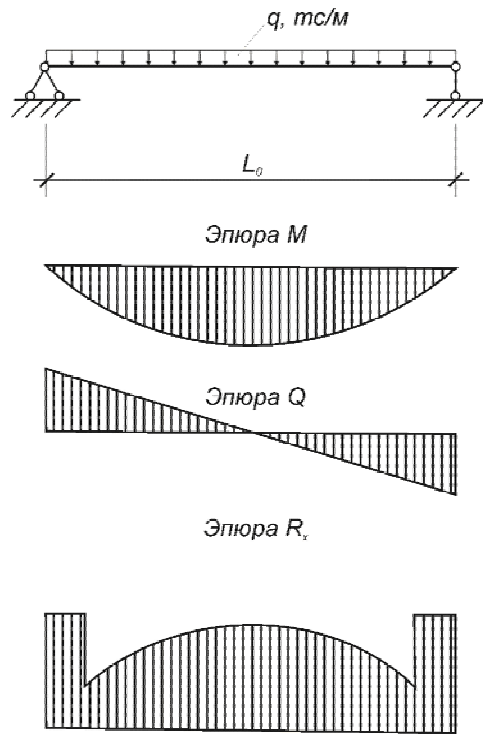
Расчетные и контрольные эпюры для однопролетной железобетонной балки.
